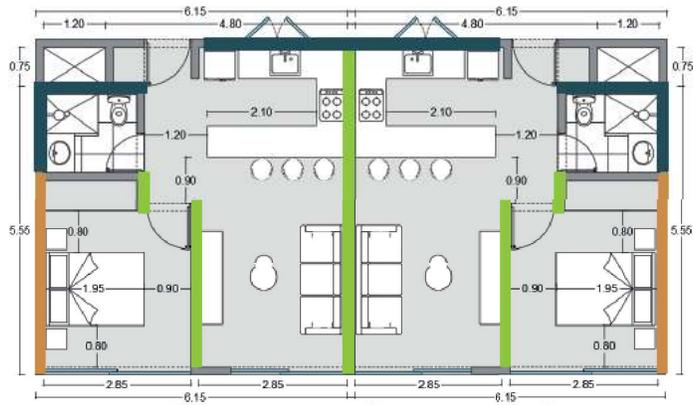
Plano de la Micro Vivienda Tipos de Muro
